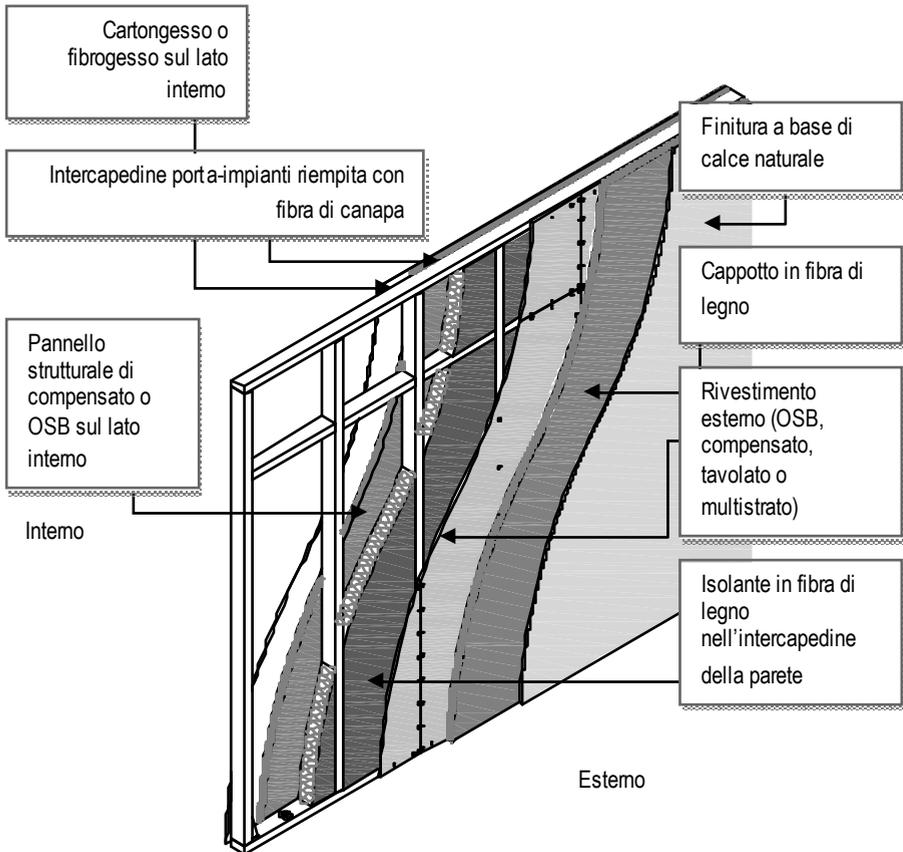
Esempio di pacchetto costruttivo completo per una parete Platform.
